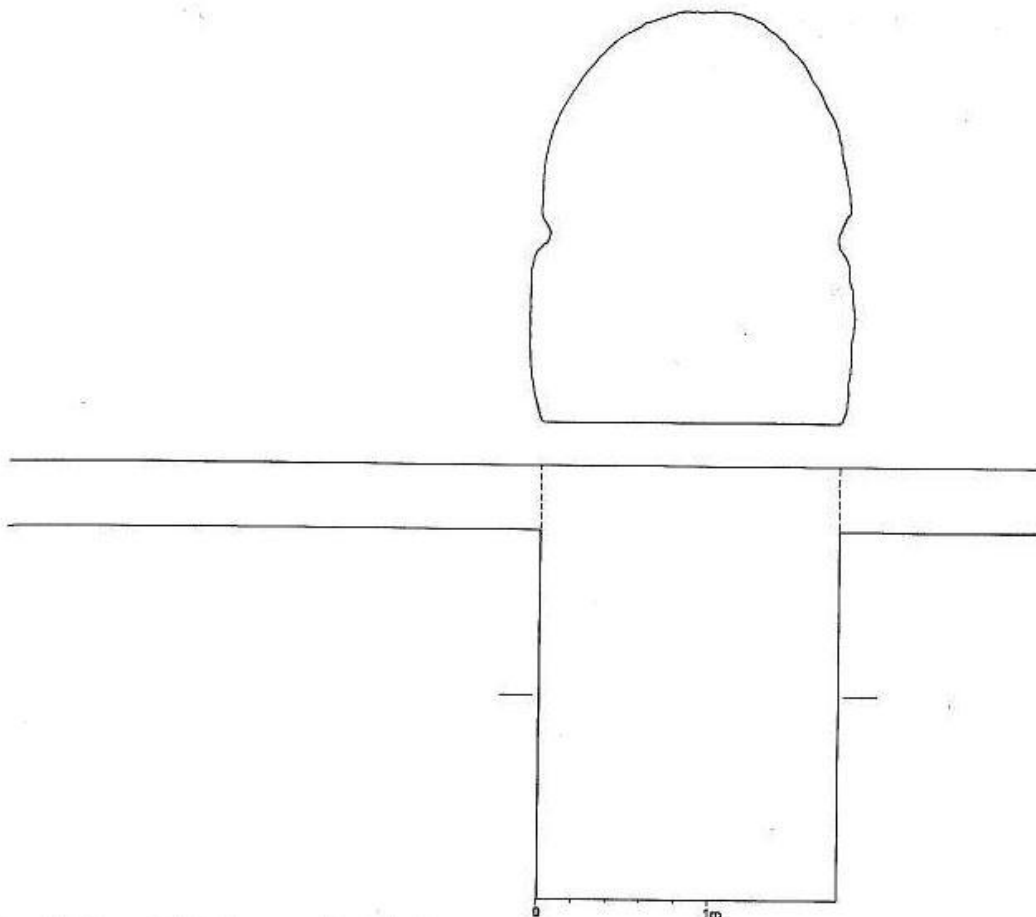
Planta y sección de la cámara subterránea de La Fuente Vieja (GARCÍA Y RUFETE, 1996)
